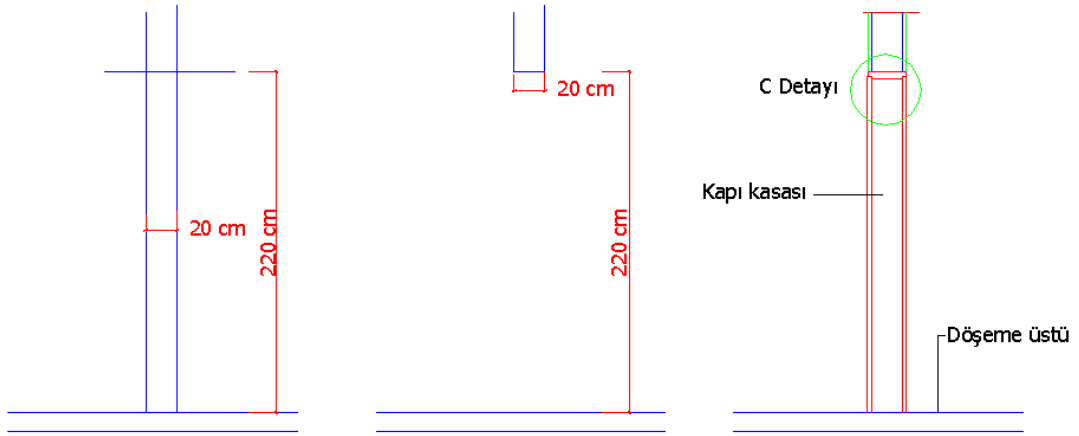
1/50 ölçekli uygulama projelerinde kapı planı görünümü
